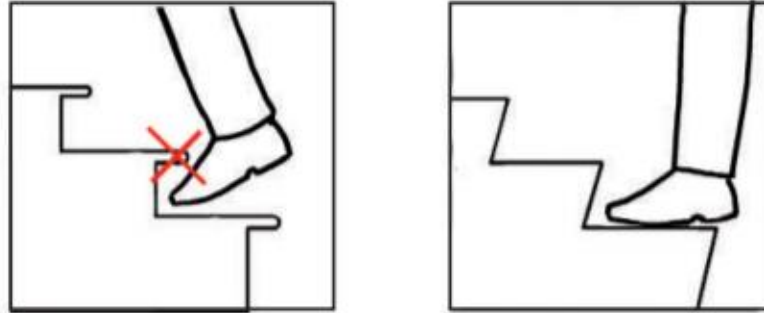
Les avantages d'un profil de marche en Z, Source : Guide pour la construction d'un bâtiment accessible
